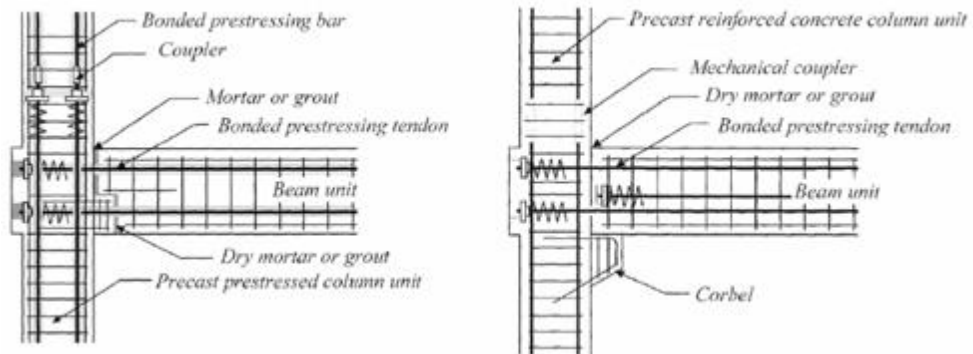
Vigas prefabricadas postensadas y apoyadas entre columnas (Blandón & Rave, 2016).
